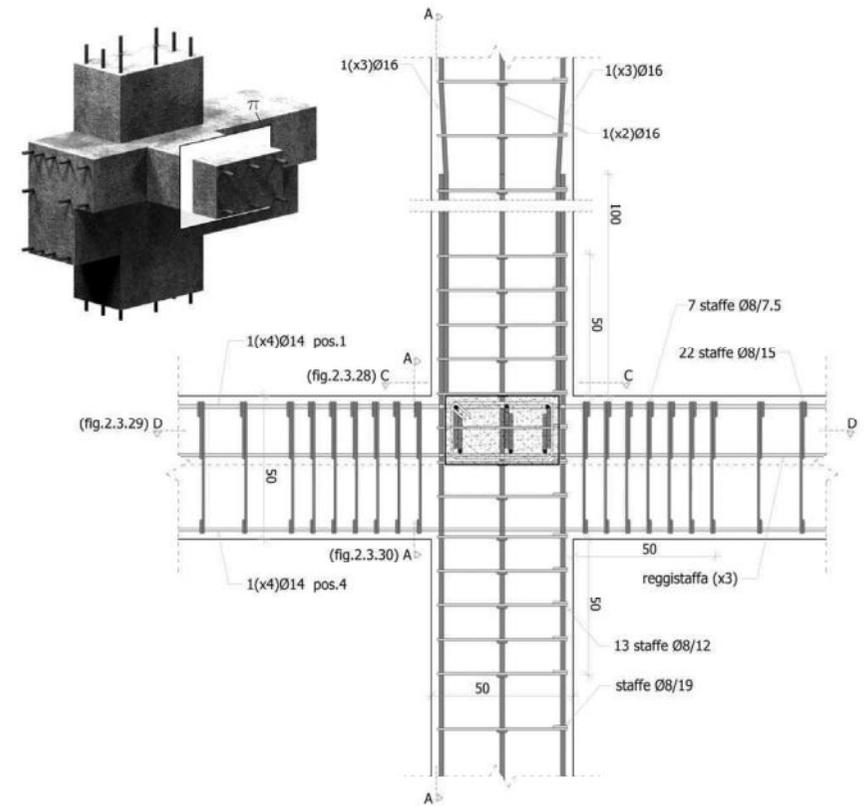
Particolare 1: sezione B-B sul cordolo
